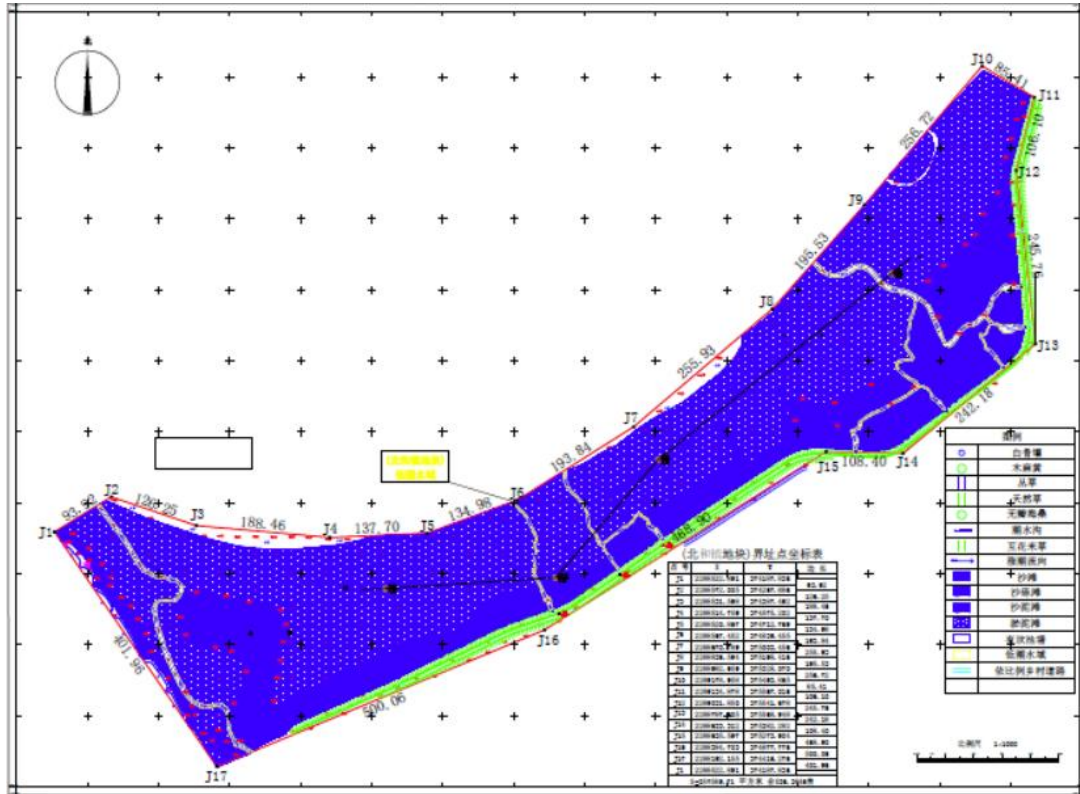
北和镇工程地质勘察钻孔平面布置图
